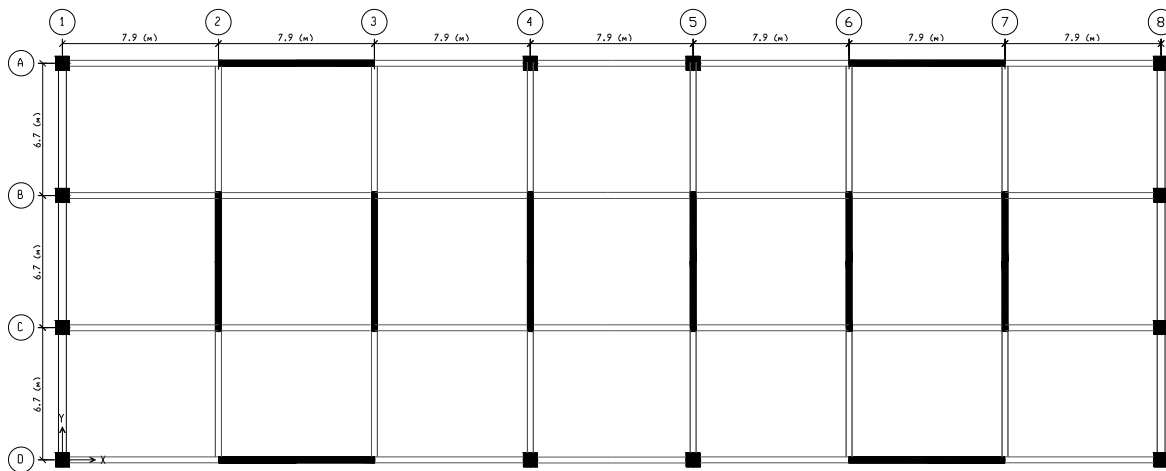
Planta tipo del edificio (todos los pisos).
